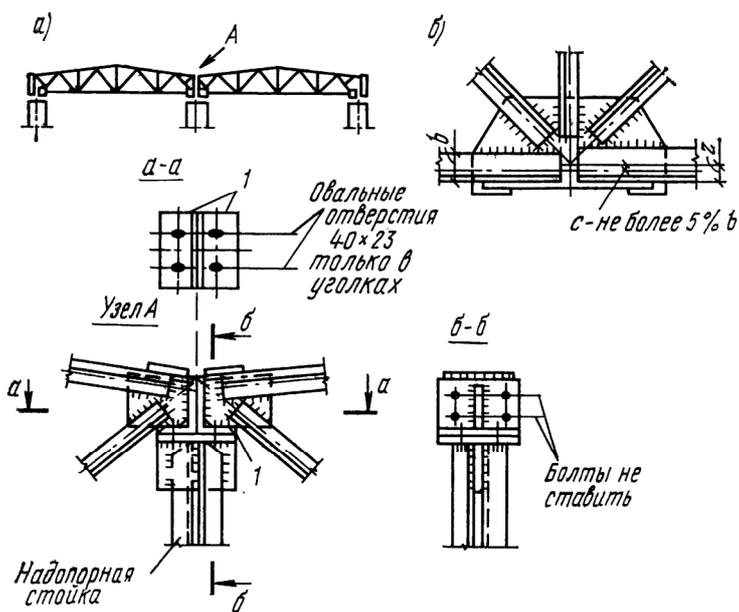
Обеспечение соответствия расчетной и конструктивной схем стропильных ферм
